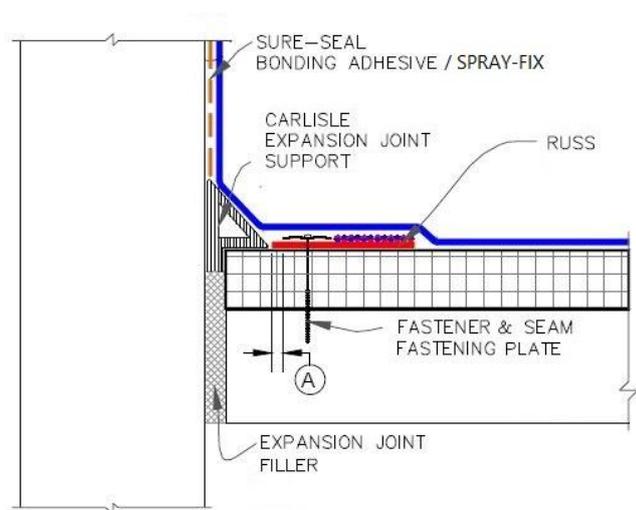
Exemple d'acrotère avec fixation au droit de l'angle
